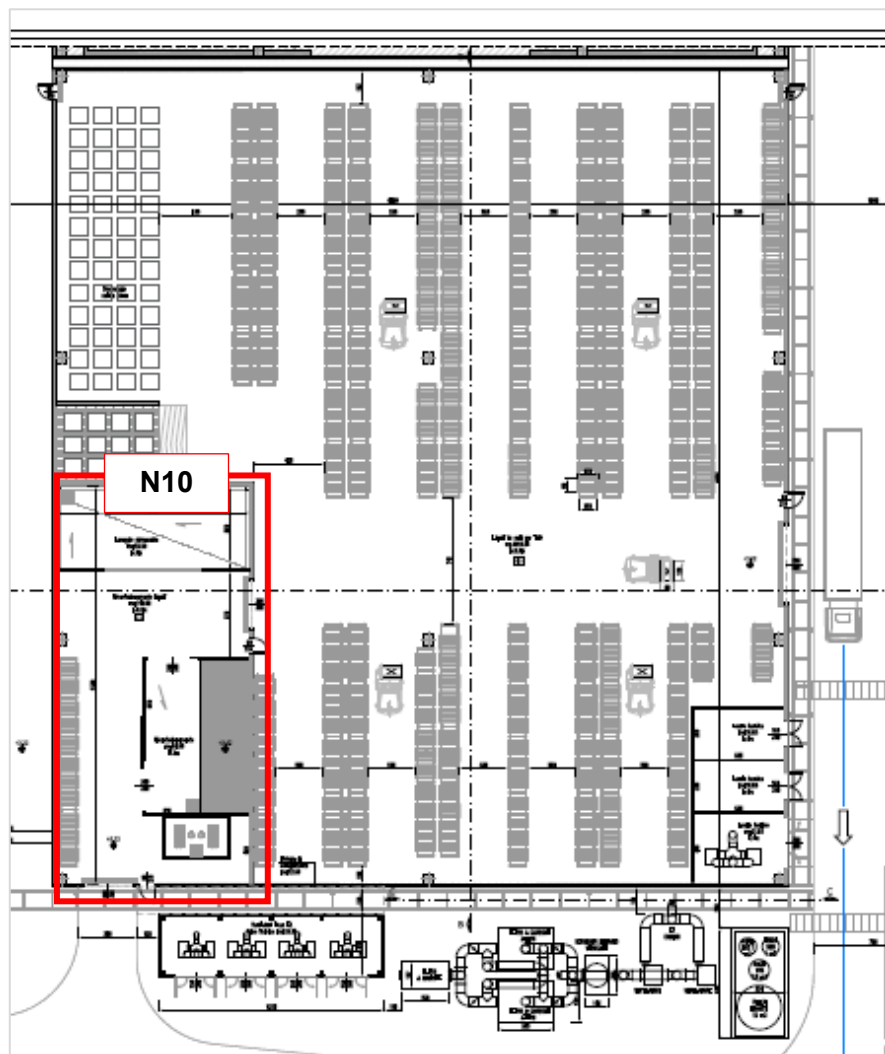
Dettaglio localizzazione Sezioni N10 (stralcio elaborato El.48.00\_CO 05 RA VA 01 D1 PL 64.00 - N8-N10 PIANTE)
